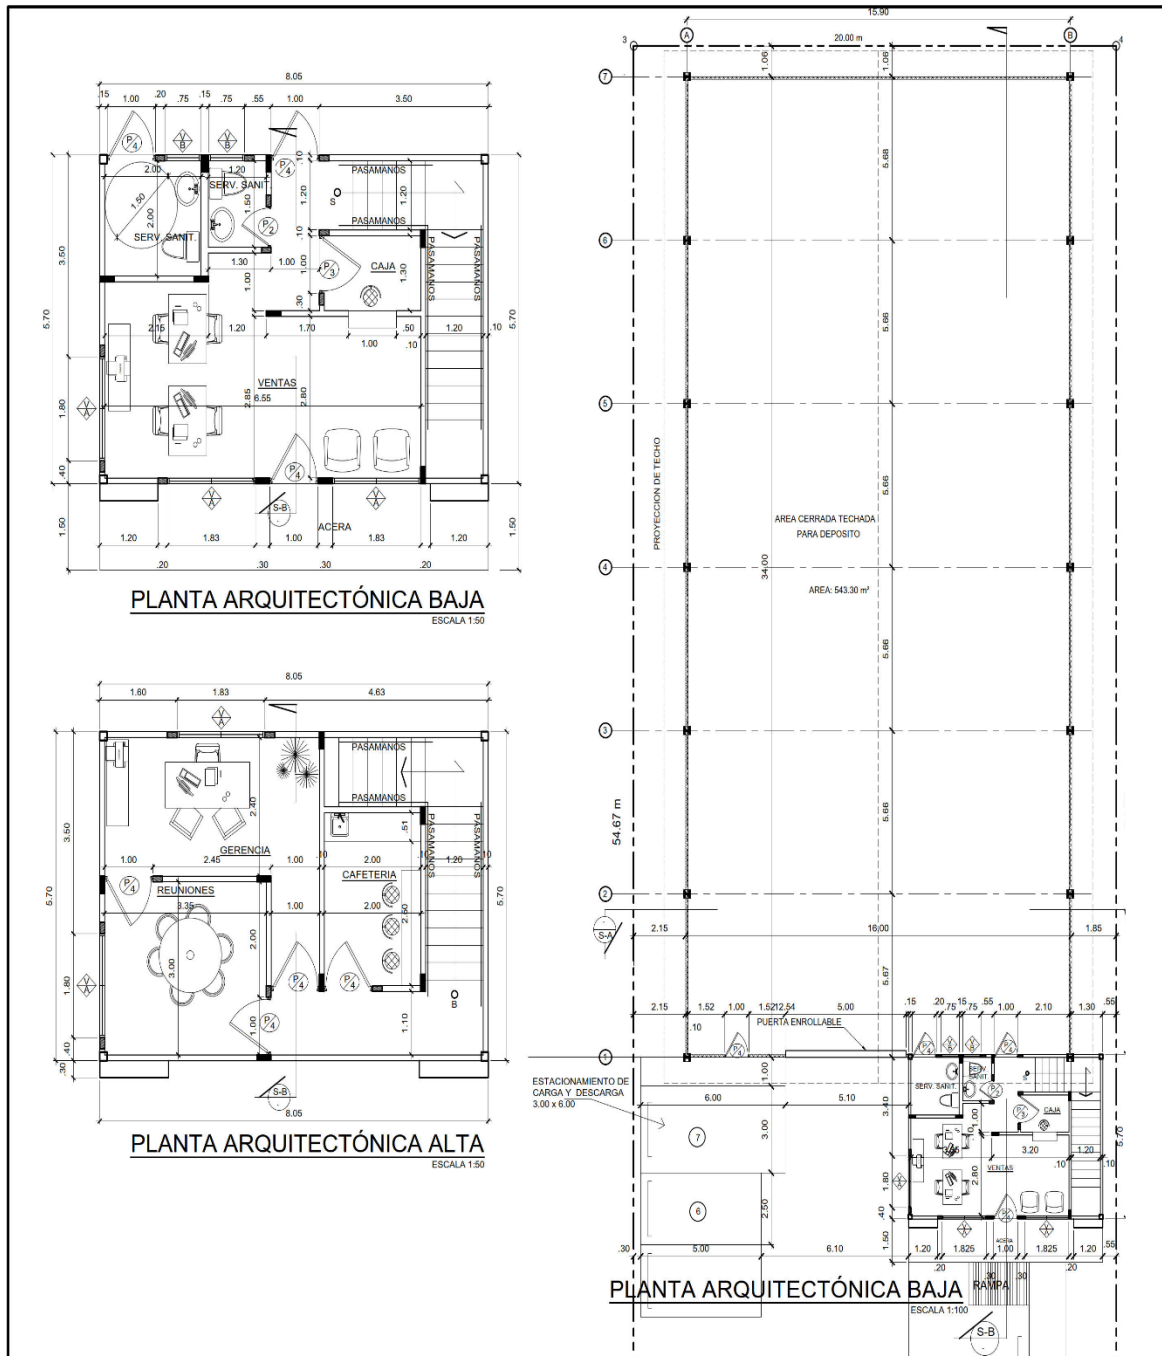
Planta arquitectónica GALERA y OFICINAS. Fuente: Plano del proyecto
